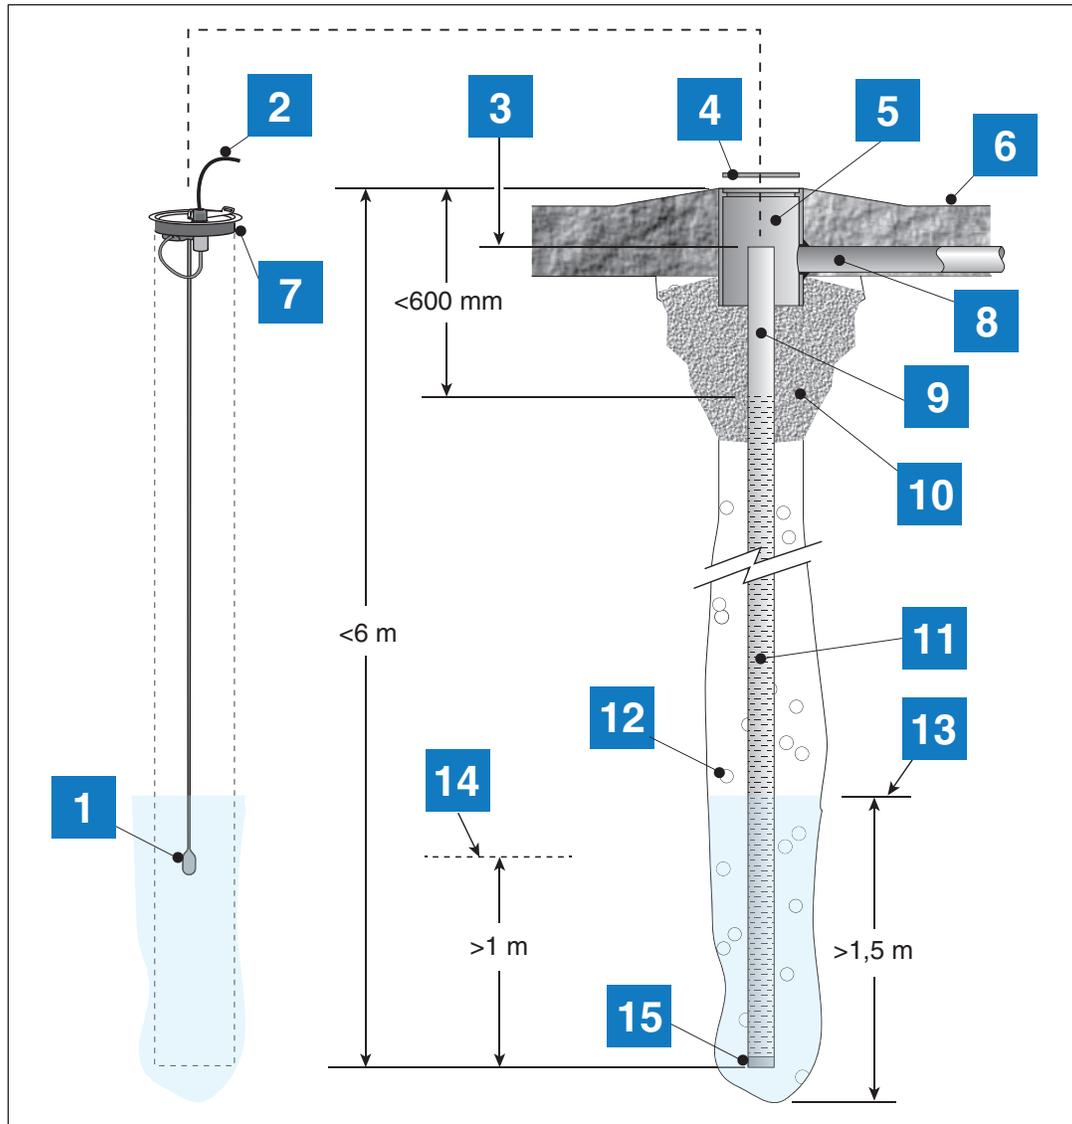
Vista de um Exemplo de Instalação de Sensor de Lençol Freático
